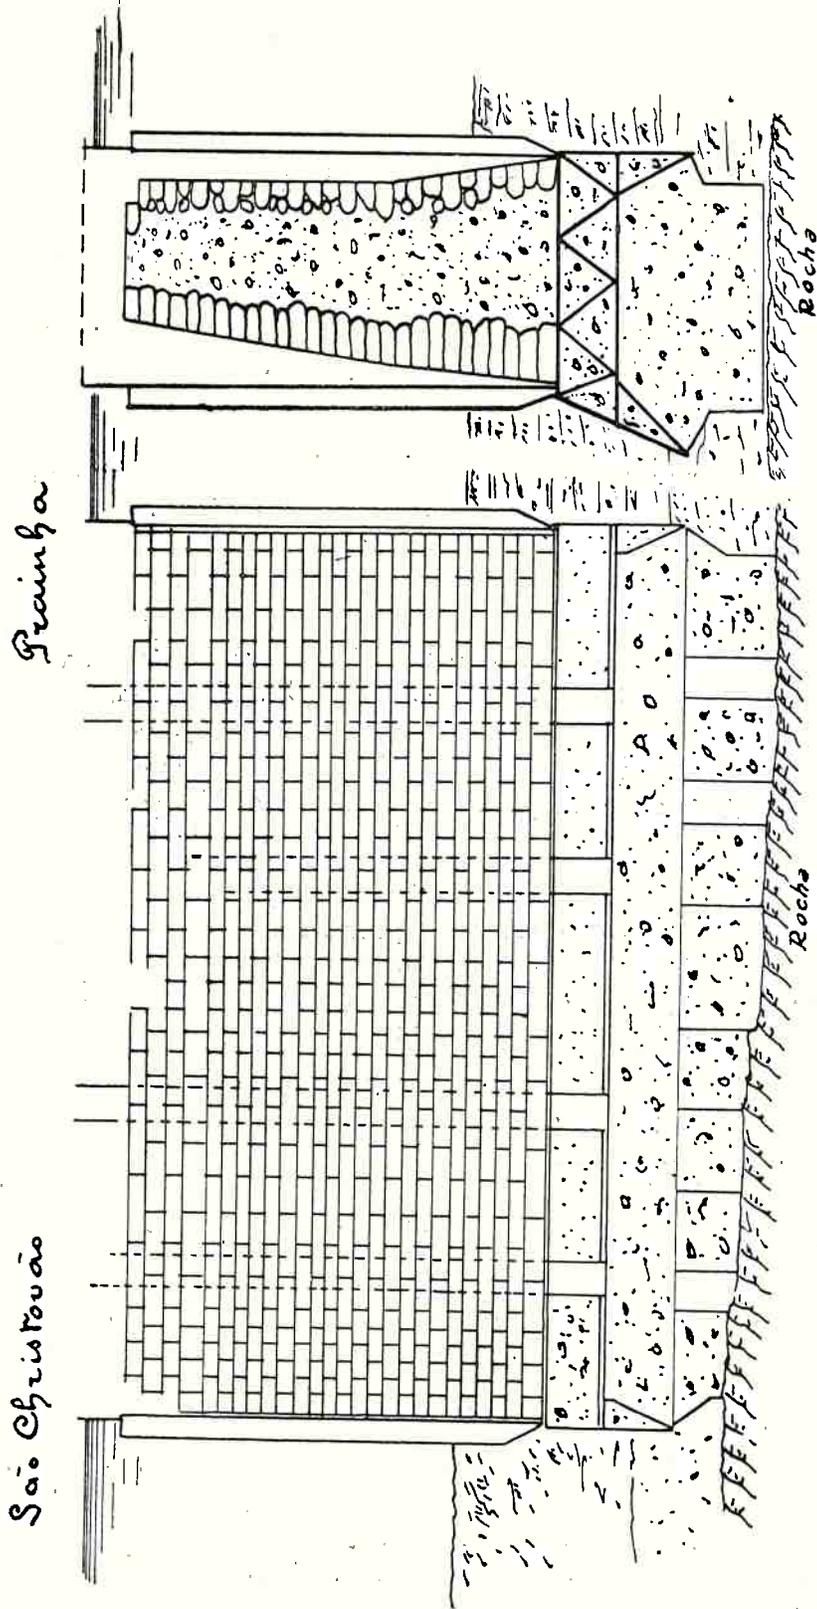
8-a — Seções longitudinal e transversal do caixão n.º 35 do Porto do Rio de Janeiro.
